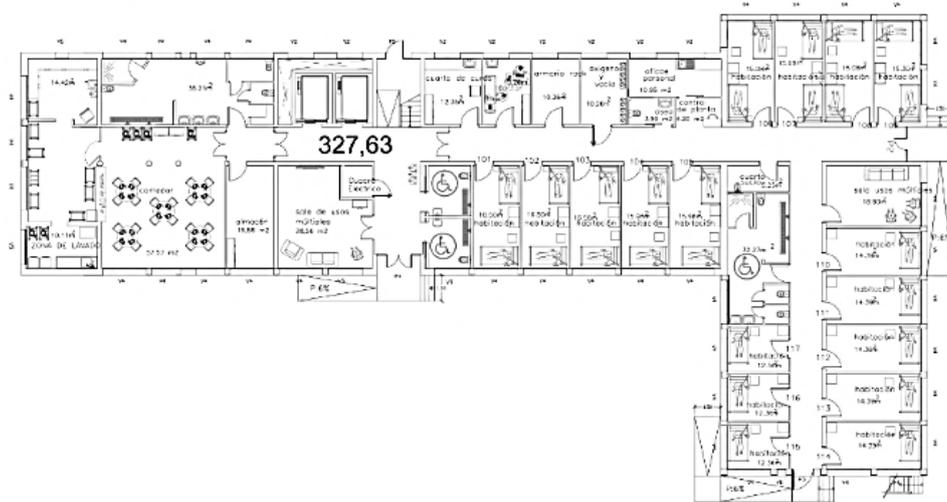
Plano actual de la planta baja del pabellón 6. Fuente: Cabildo de Gran Canaria.
